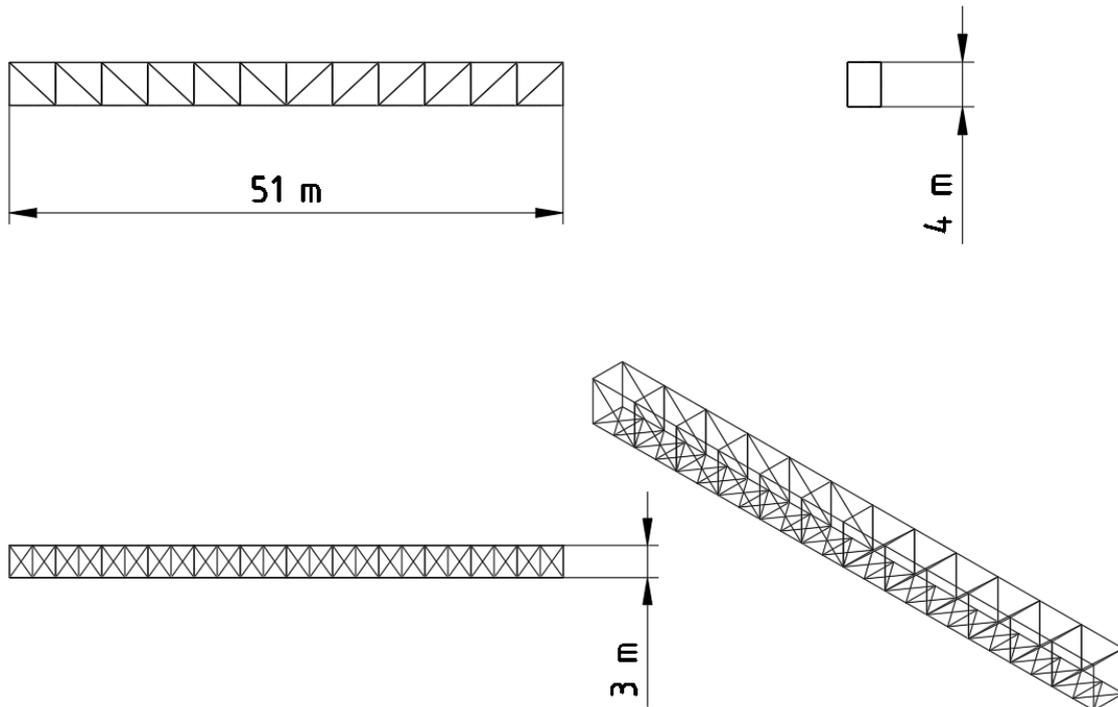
Alzado, planta, perfil y 3D de la estructura básica de la pasarela.
